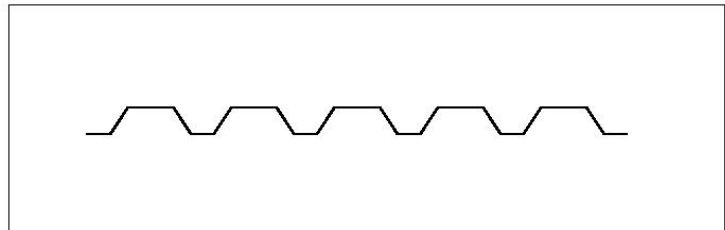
Planta do “drapeado” do betão aparente no revestimento do embasamento do armazém
